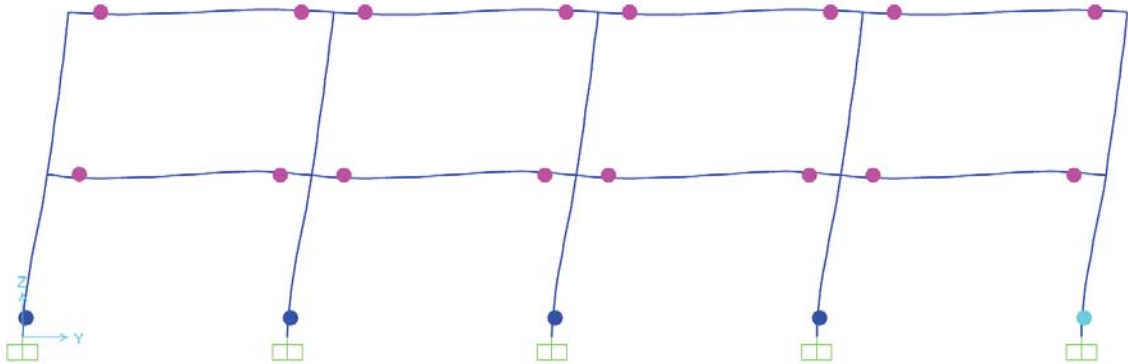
Columnas exteriores en el estado de resguardo de la vida
